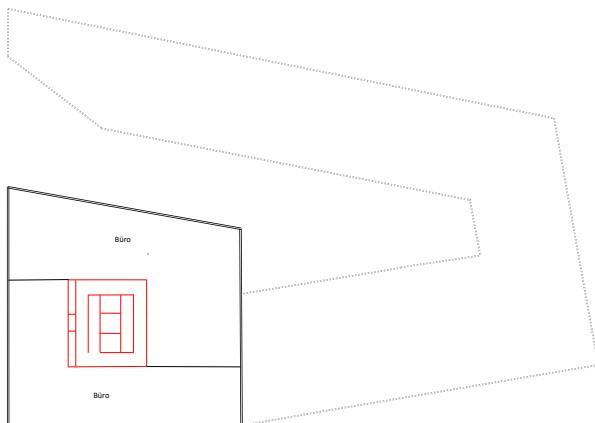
Grundriss E+9 bis E+19
